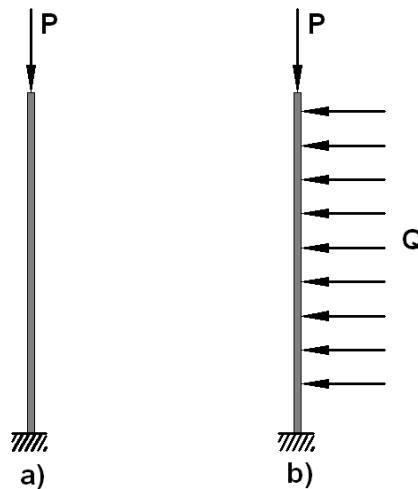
a) Columna empotrada sometida a compresión simple, b) Columna empotrada sometida a compresión y flexión.
